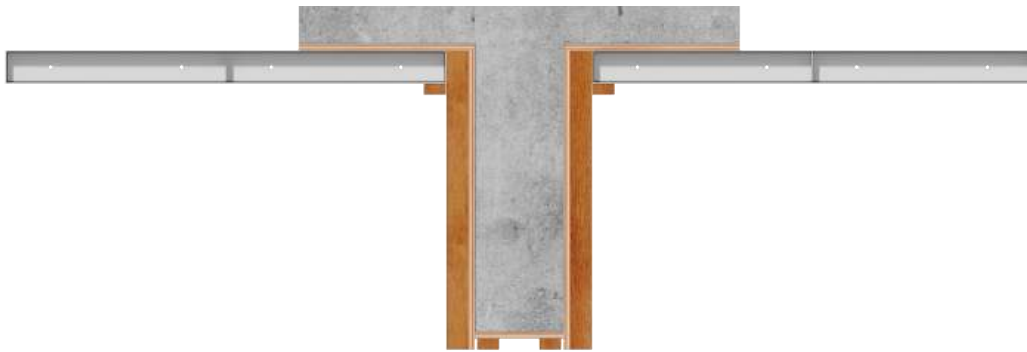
Apoio do secundário em guia da lateral da fôrma para viga
